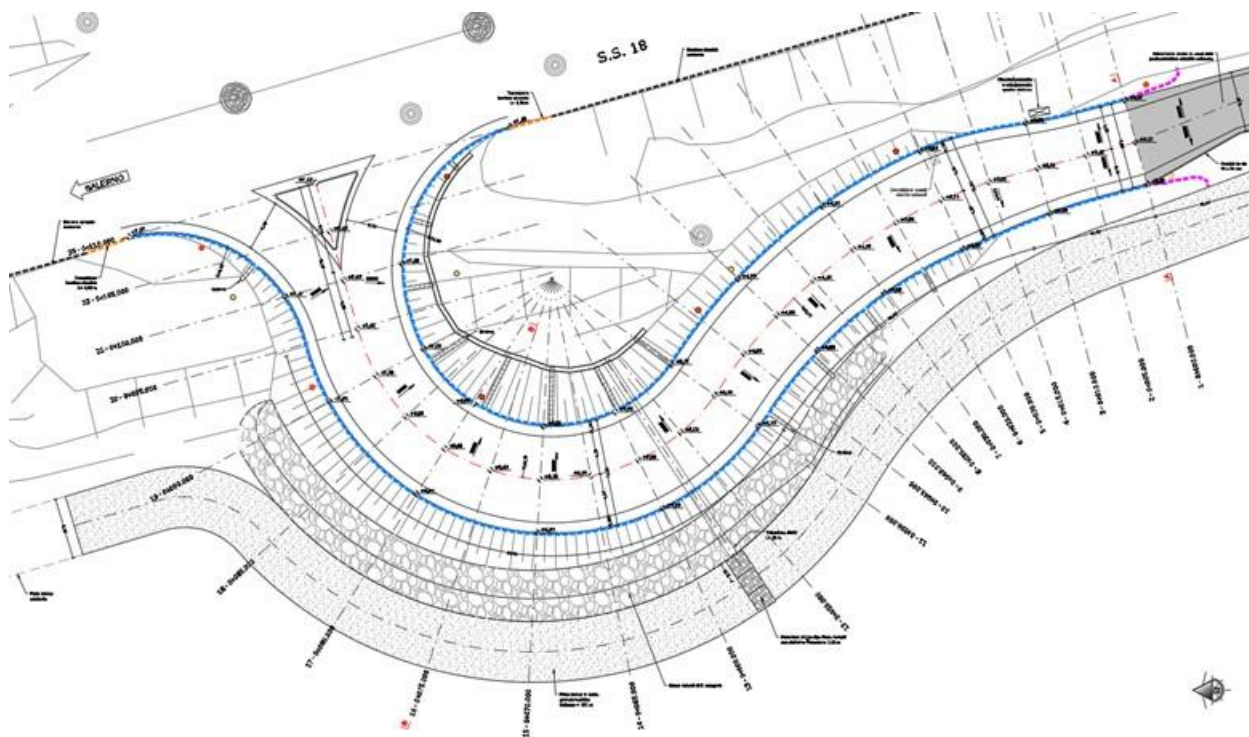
Planimetria raccordo di collegamento porto - SS18
